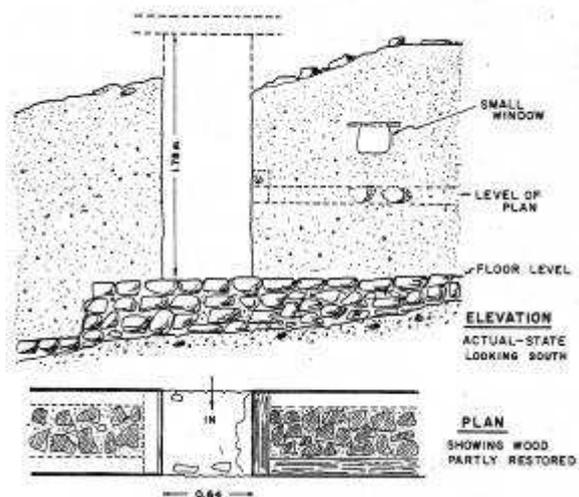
Vasiliki (Creta). Pianta e prospetto di una parete con porta d'ingresso e rinforzi lignei (SHAW 1973)
